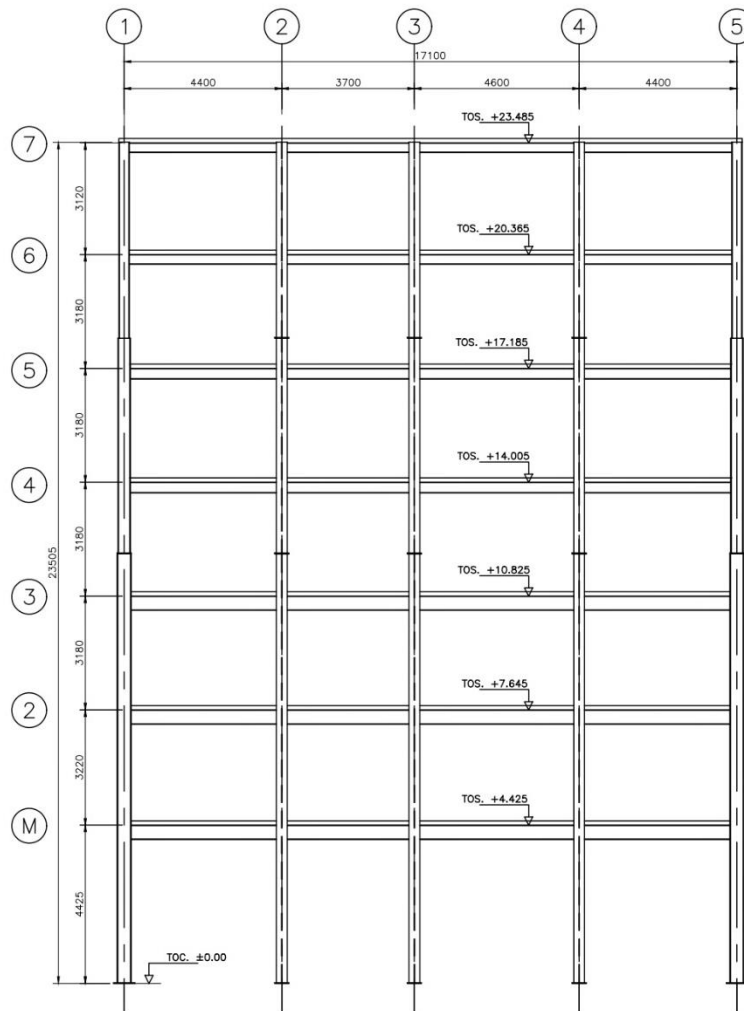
Vista en elevación pórtico tipo 2 (medidas en mm.)
